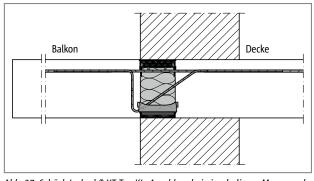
Schöck Isokorb $^{\circ}$  XT Typ KL: Anschluss bei einschaligem Mauerwerk
